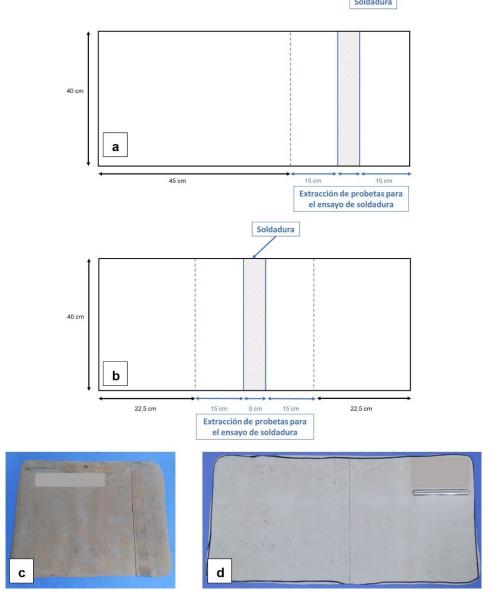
Material a extraer: (a) esquema de la muestra con la soldadura en un extremo, (b) esquema de la muestra con la soldadura centrada, (c) y (d) muestras extraídas de una geomembrana de PVC-P reforzado con geotextil tejido
